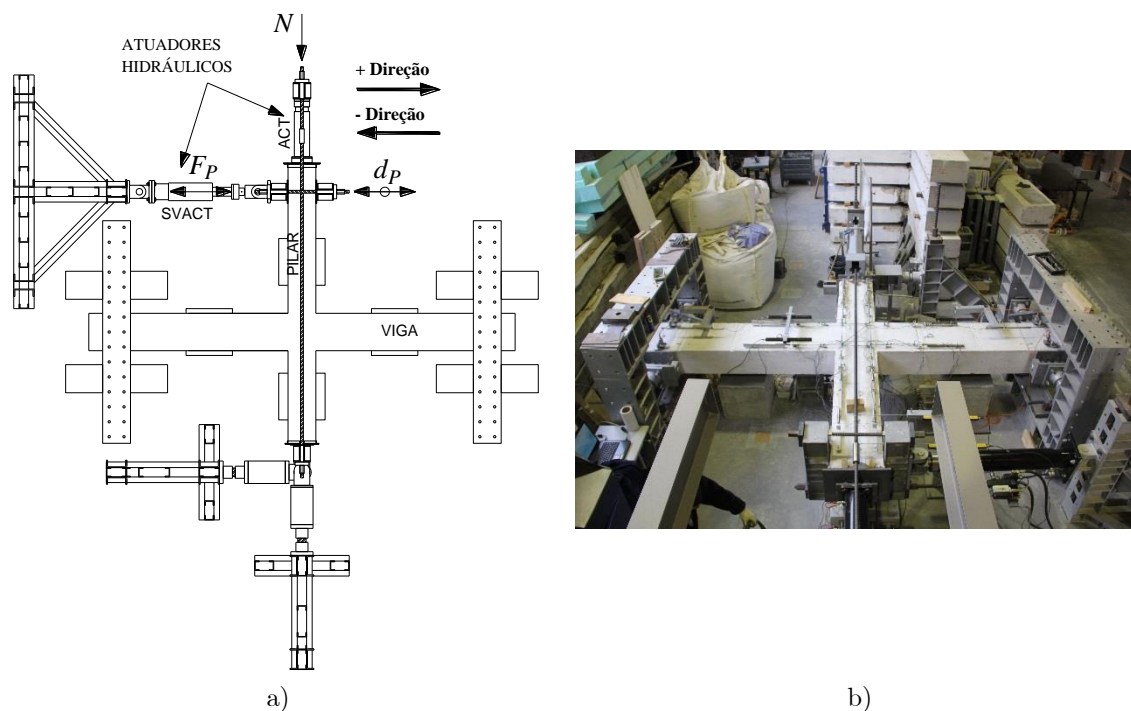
Plataforma de ensaio: a) Em planta; b) Vista global.
